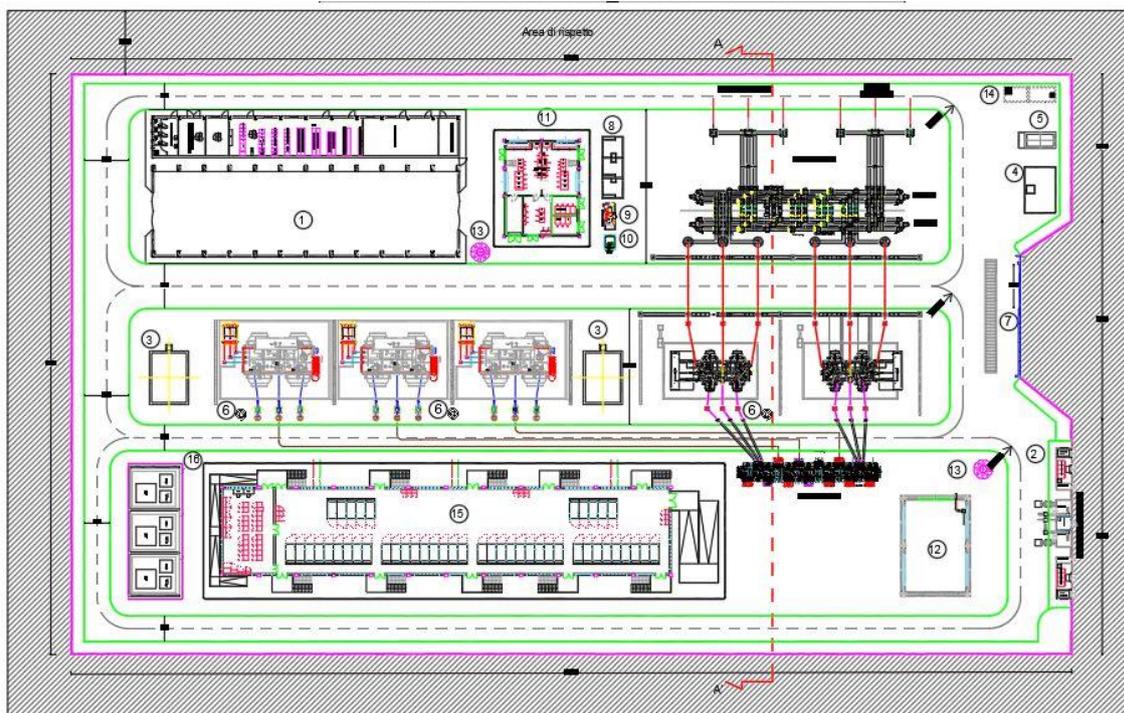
Ipotesi della pianta elettromeccanica della stazione 380/132/36 kV
